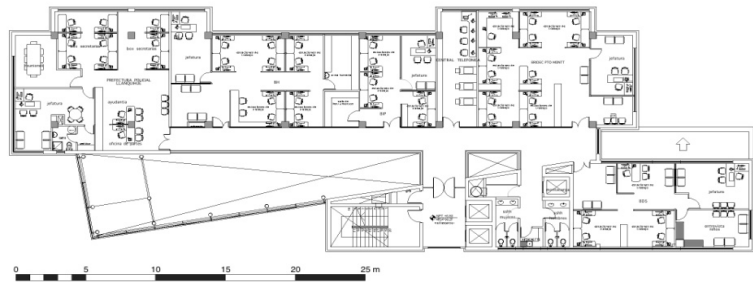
Planta Piso 3 – Oficinas – Nivel +6,80
